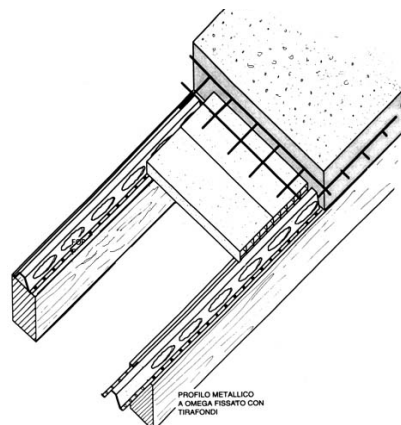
L.P.R. , Peter Cox (ref. 33 y 34)
